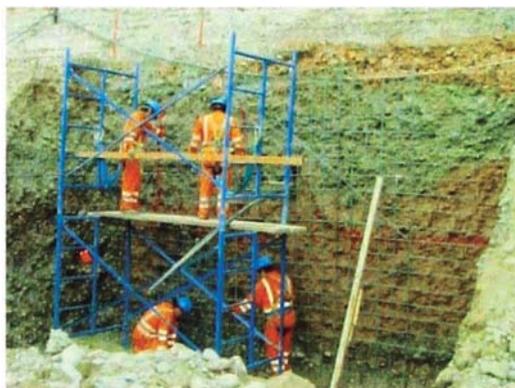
Colocación de acero y malla de refuerzo para el anclaje
